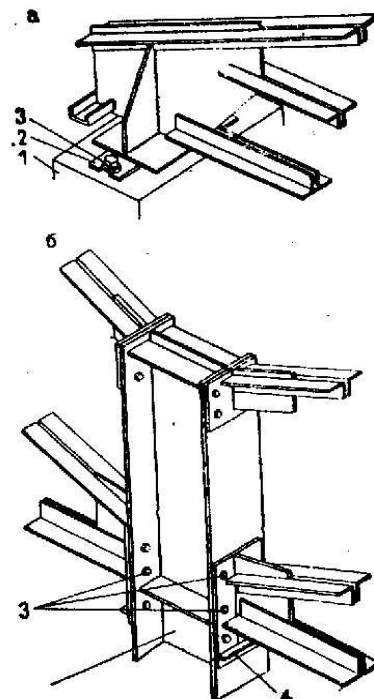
Сопряжение стропильных ферм с колоннами
